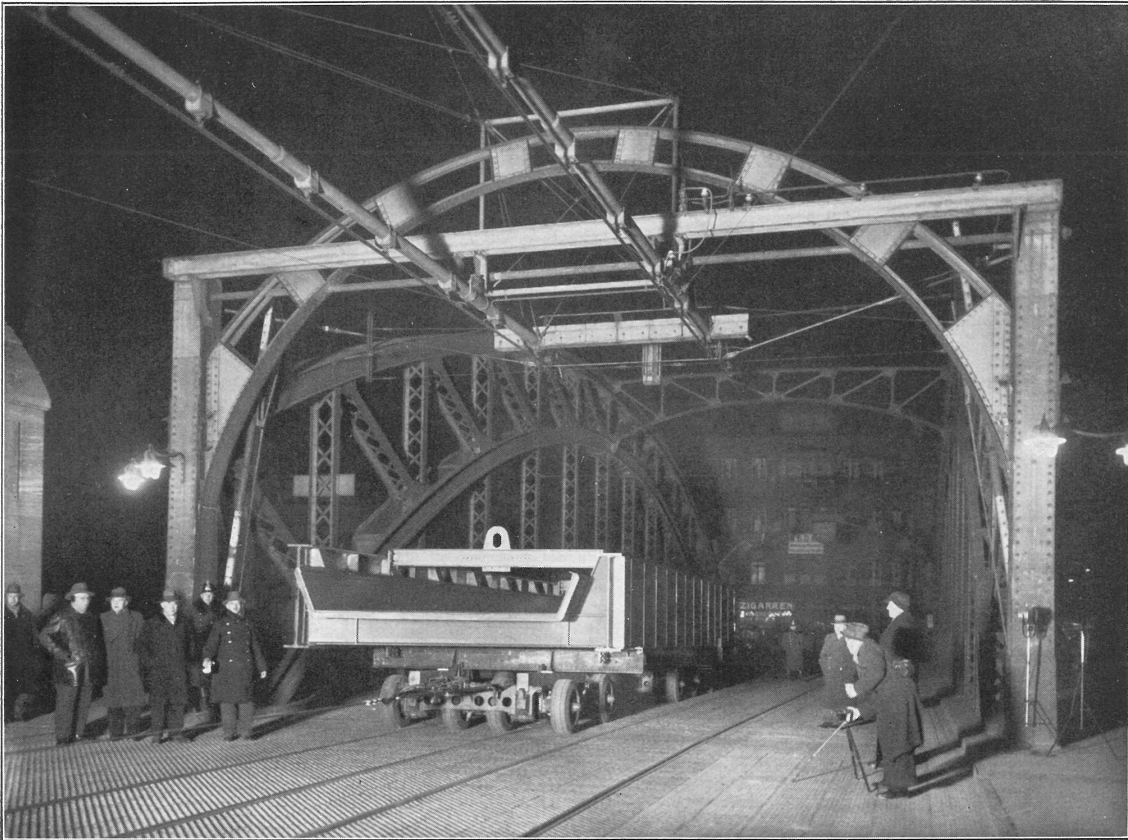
Nächtlliche Beförderung einer Eisenbahnbrücke über eine Straßenbrücke in Stettin
